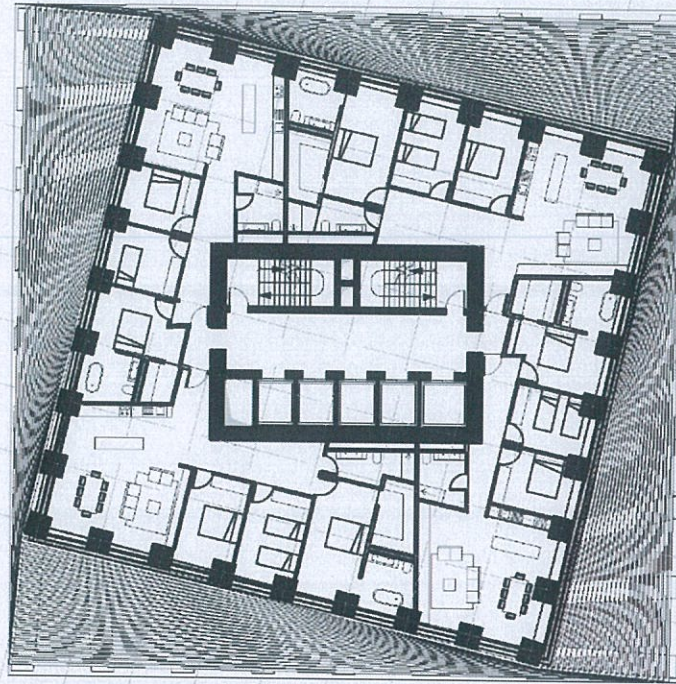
Planimetri e katit +25, në kuotën +98.28 (Skema e funksionit banim, kati 25-49)
